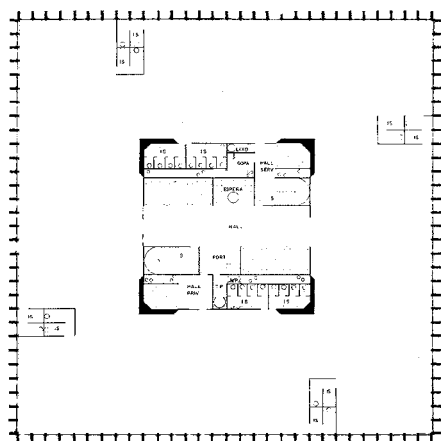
4º prêmio concurso BNDE DF; planta tipo;
